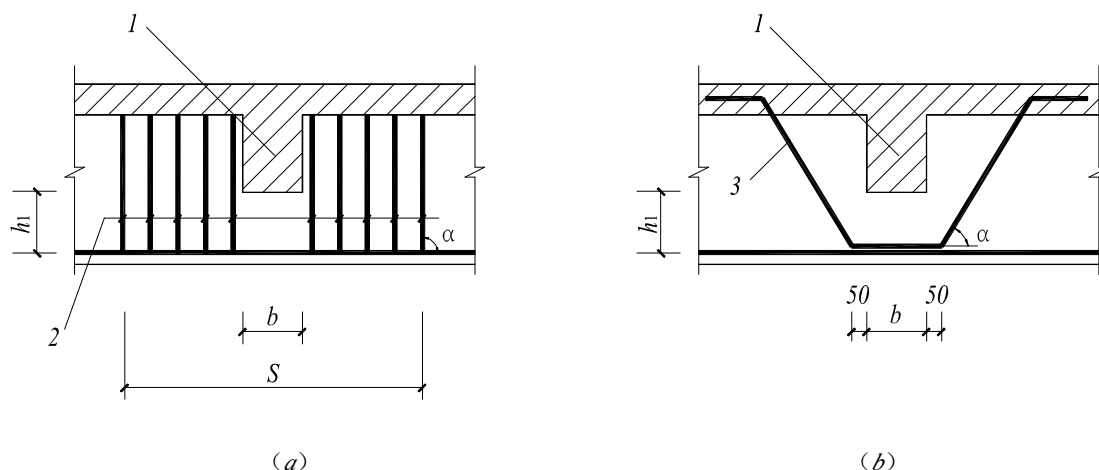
梁截面高度范围内有集中荷载作用时附加横向钢筋的布置
